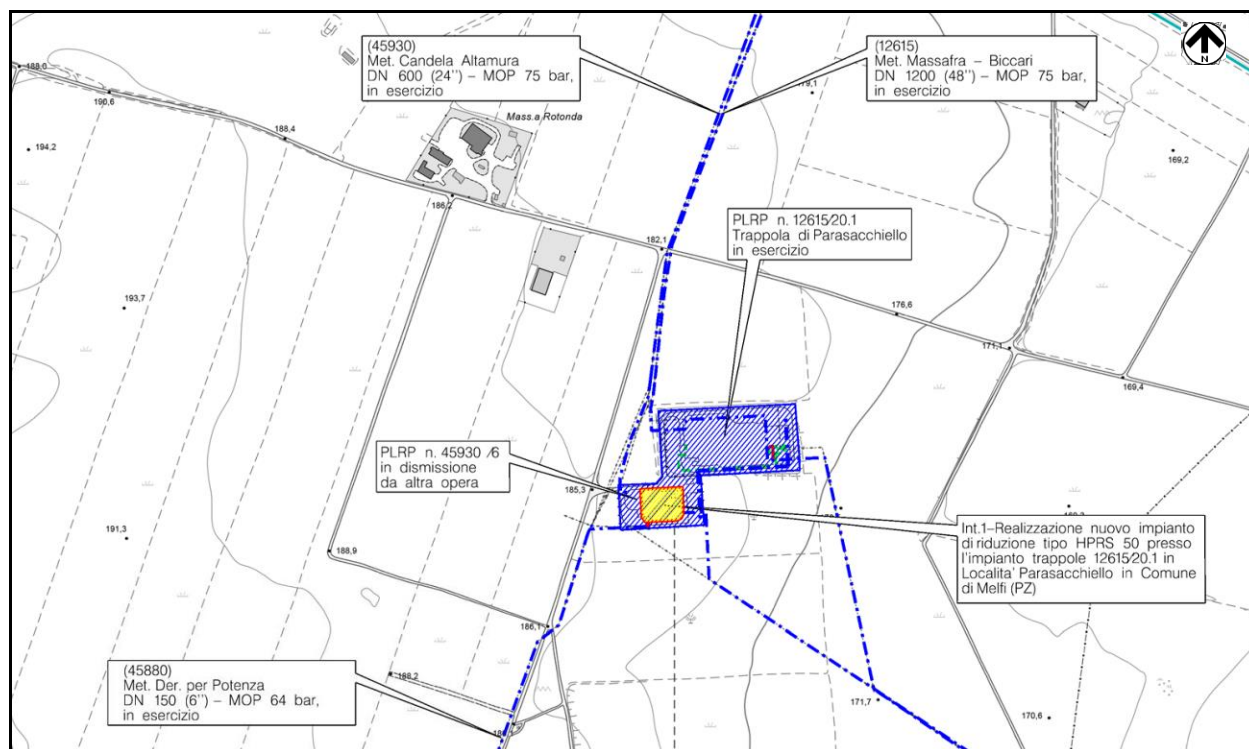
/A.b – Planimetria 1:5.000 con localizzazione dell'area dell'Intervento n.1 (progetto in rosso, dismissione in verde, esistente in blu)
